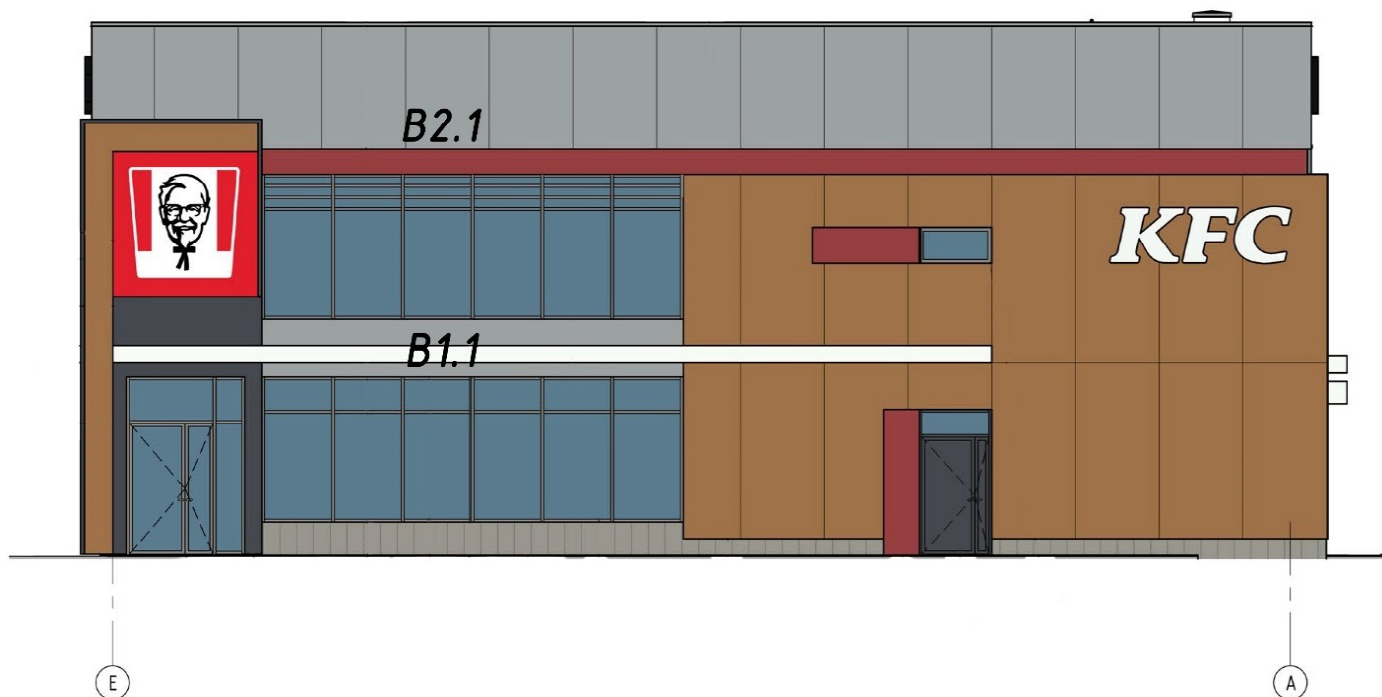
I варіант фасаду Е-А ( 2-х опорна конструкція)
